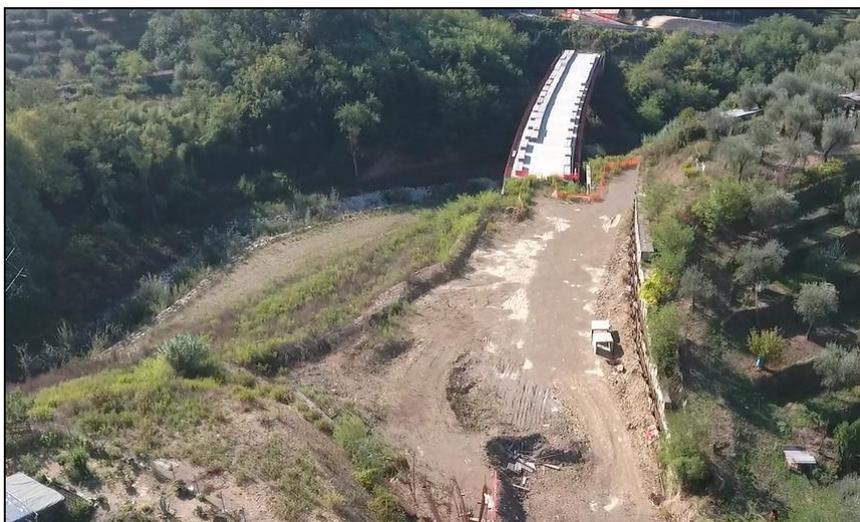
Vista aerea dello stato attuale dell'area di cantiere prevista
